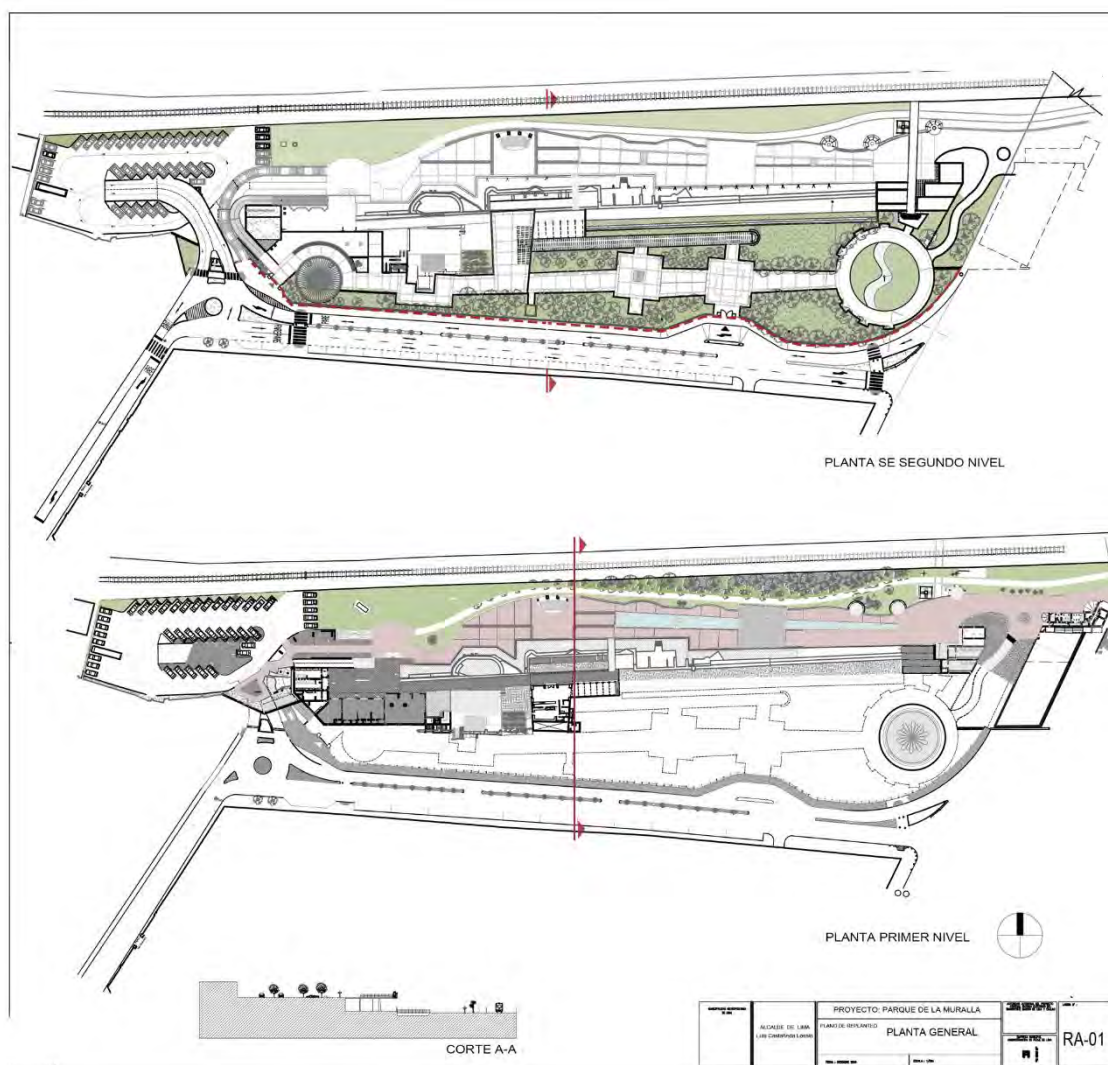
Plano general Parque de la Muralla: plantas de primer y segundo nivel. Fuente: Gerencia de Proyectos y obras SERPAR, 2004.
